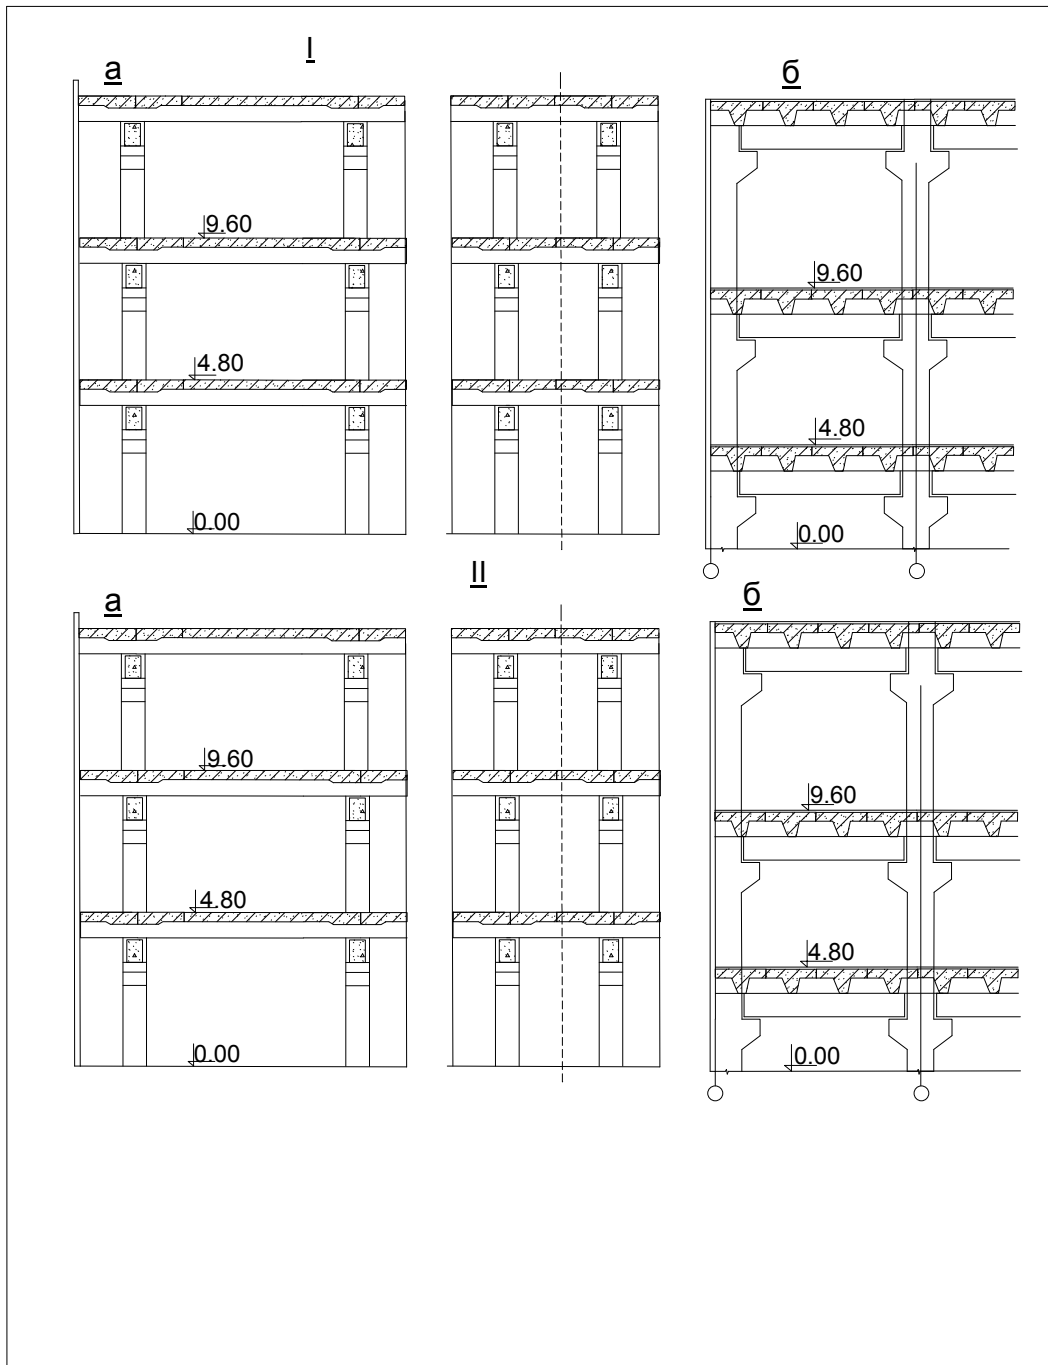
Конструктивні схеми багатоповерхових промислових будівель: 1 – ригель з полицями; 2 – ригель прямокутного перерізу; а – поздовжній розріз; б – поперечний розріз
